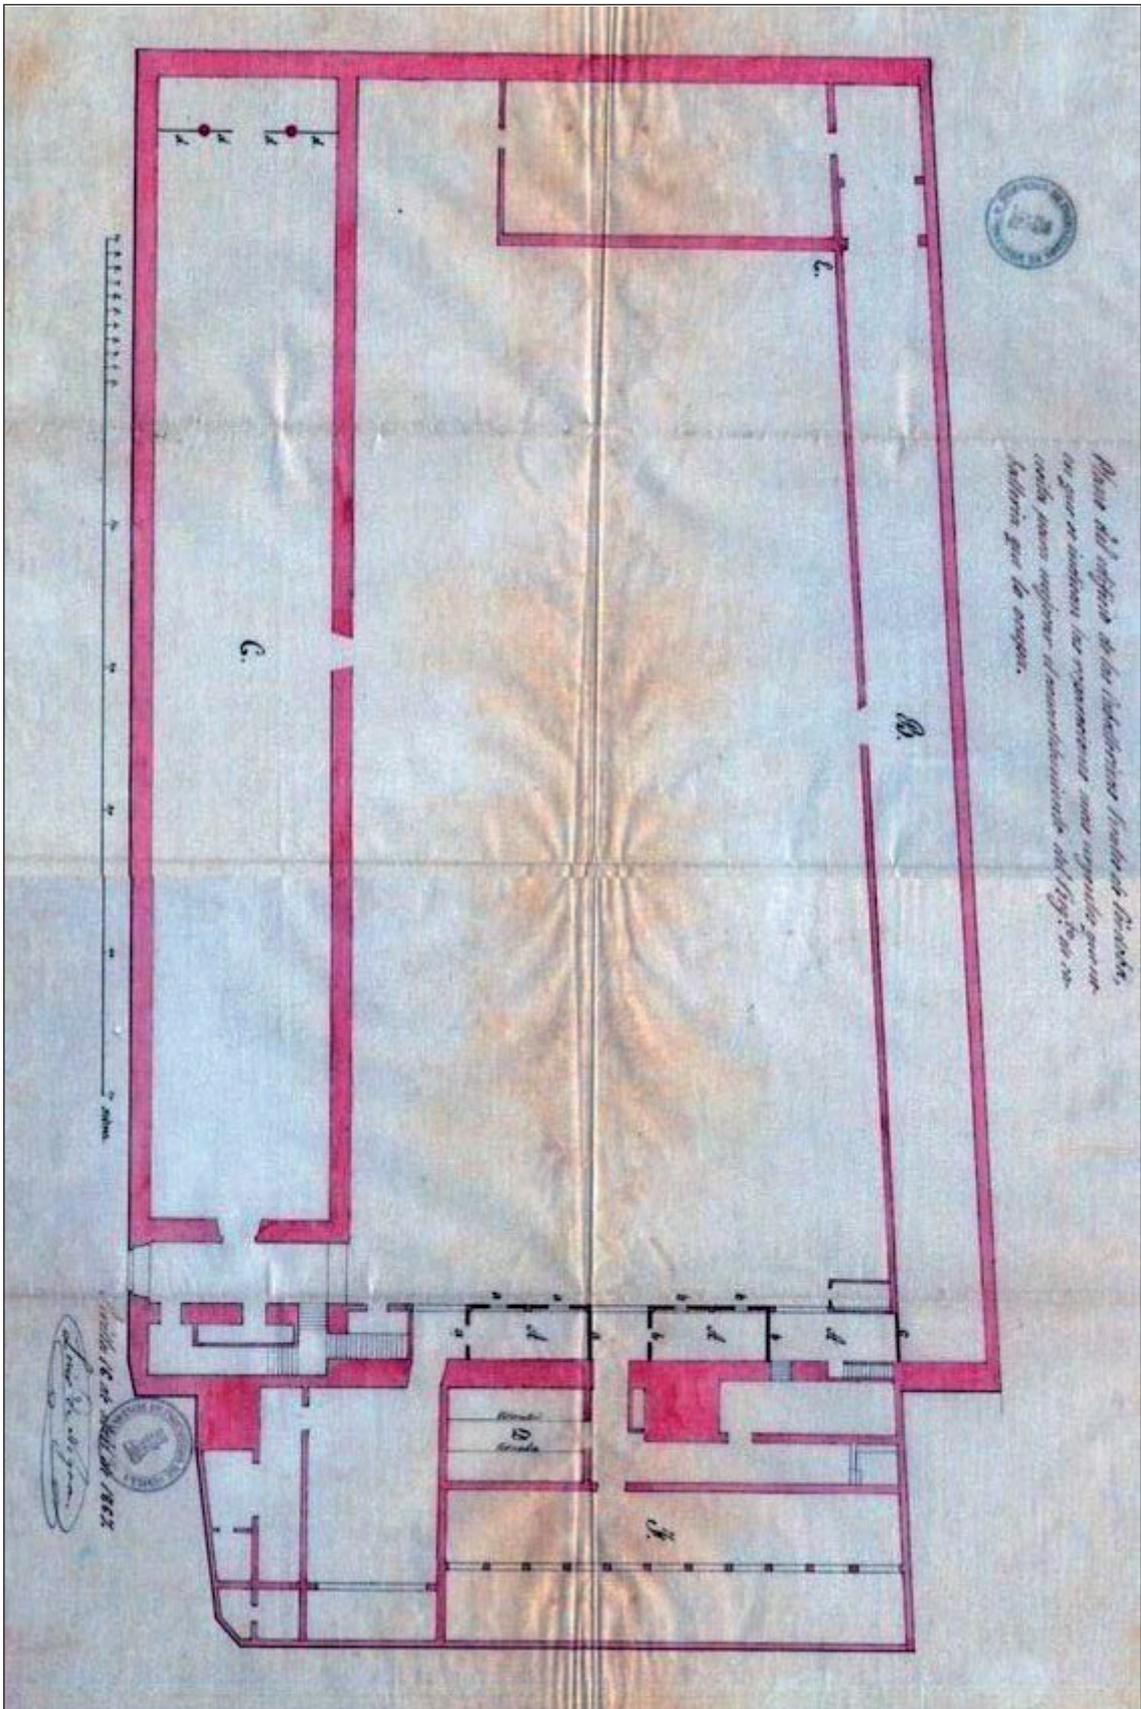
Plano de las Caballerizas realizado en 1867, previo a la construcción del picadero cubierto.
